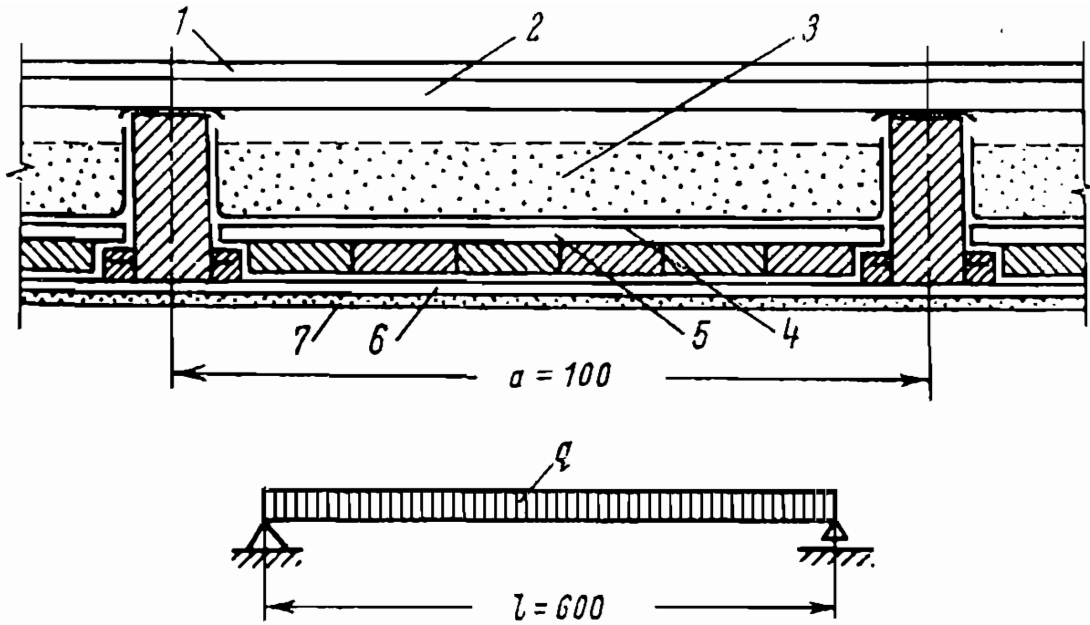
Конструкция междуэтажного перекрытия и расчетная схема
